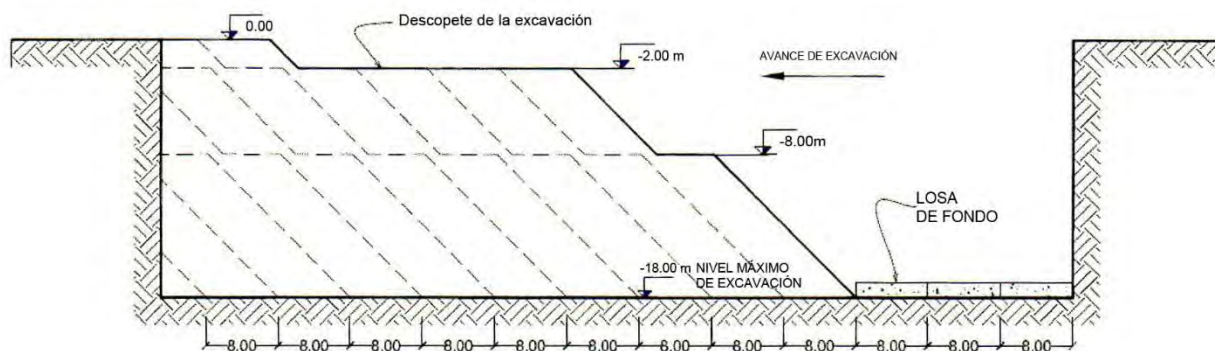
Configuración de excavación de la Estación Centro Médico L-9.
